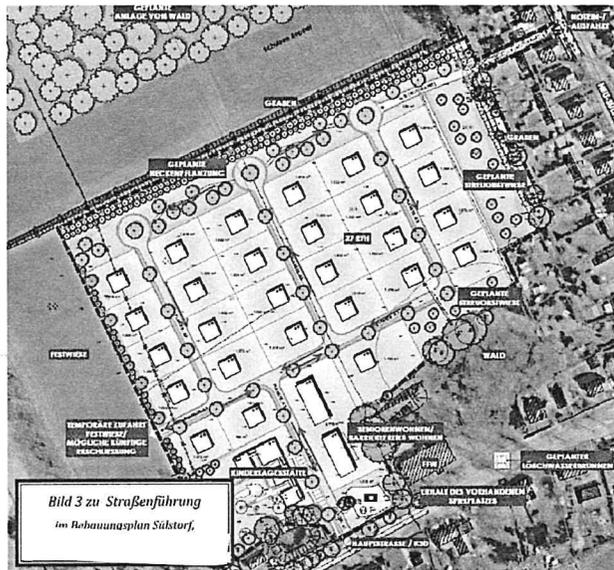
Vorschläge Straßenführung zur Minimierung von Gegenverkehr
